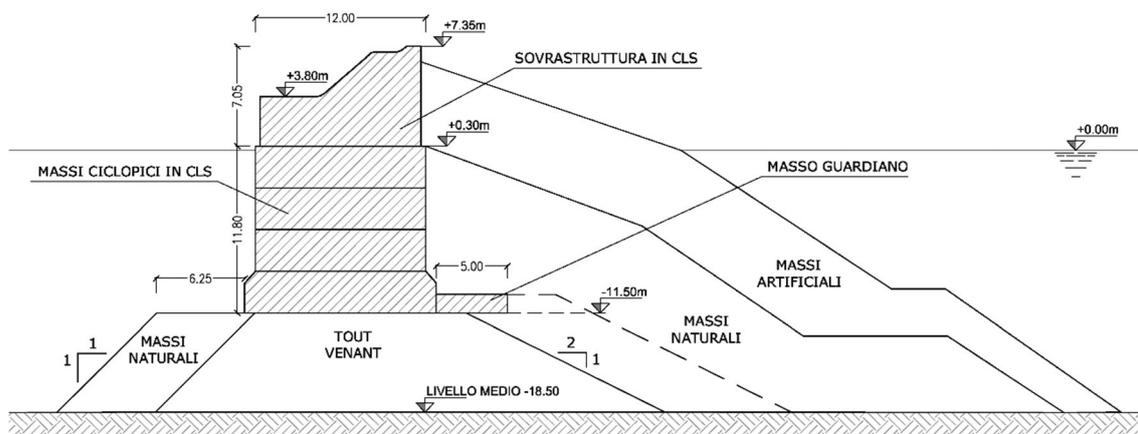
SEZIONE TIPO TRATTO A PONENTE DELLA DIGA ESISTENTE. TRATTI C'-D', D'-D
